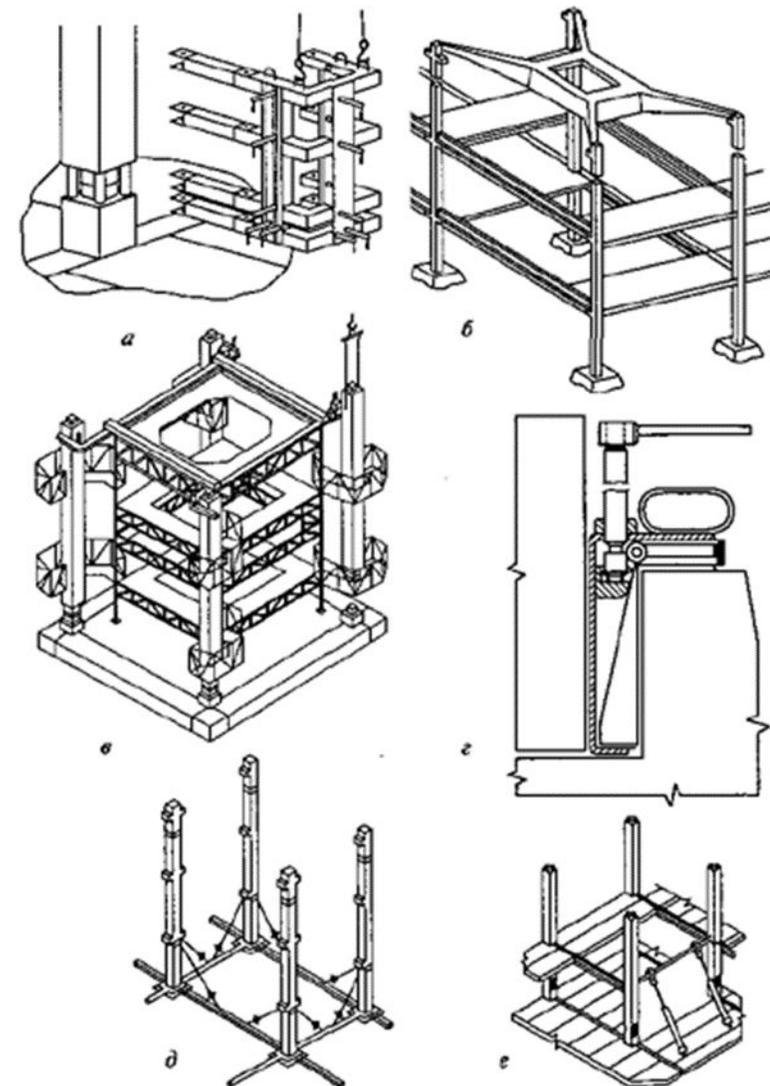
Приспособления для монтажа конструкций многоэтажных каркасных зданий:
